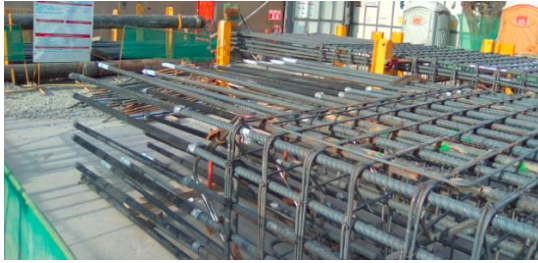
Acero de refuerzo de barretes centrales.⁷
